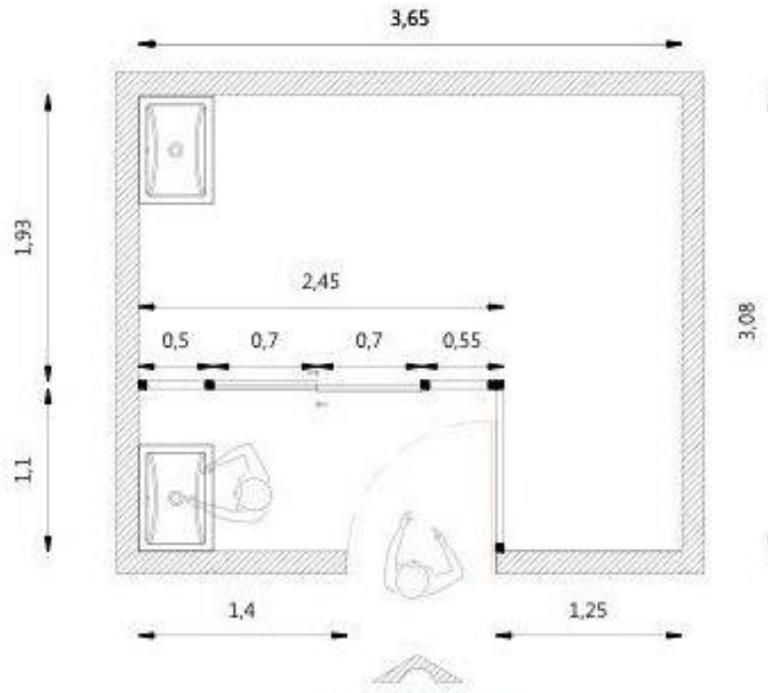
Planta Arquitectónica, Proceso Cosecha. Fuente: Spirumex, Puebla.
